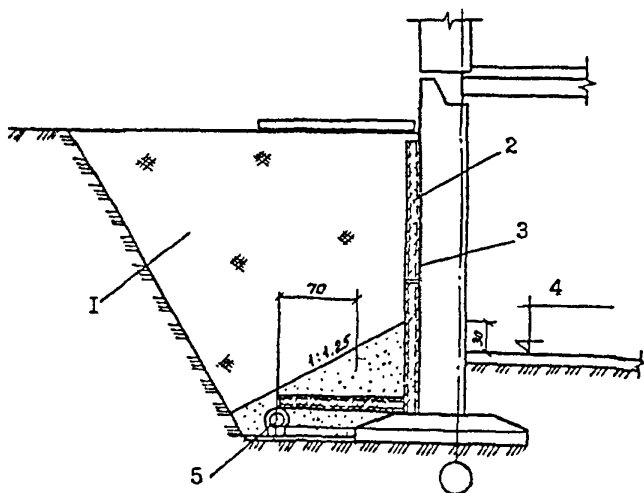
Схема пристенного дренажа здания с сопутствующим кольцевым дренажом:
